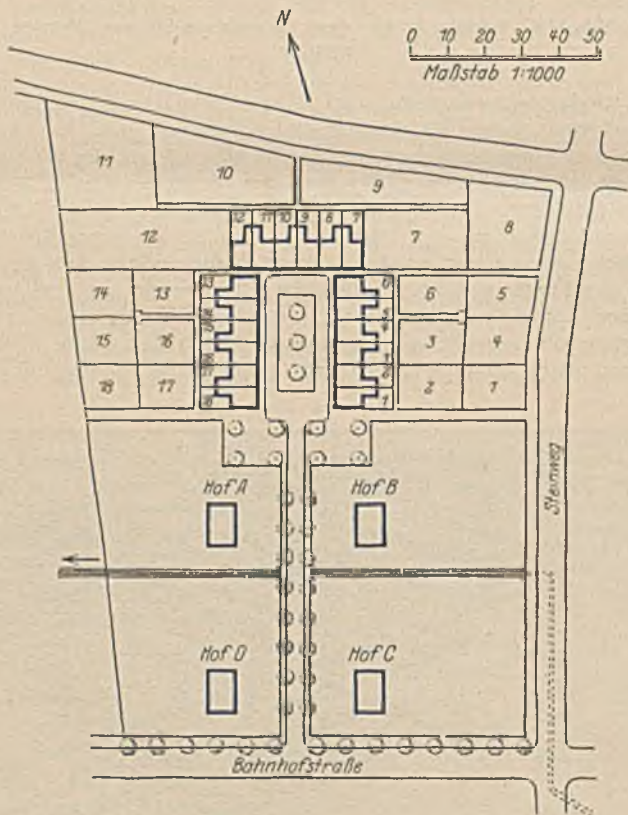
Ausschnitt aus dem Bebauungsplan von Essen (Fulcrum).
